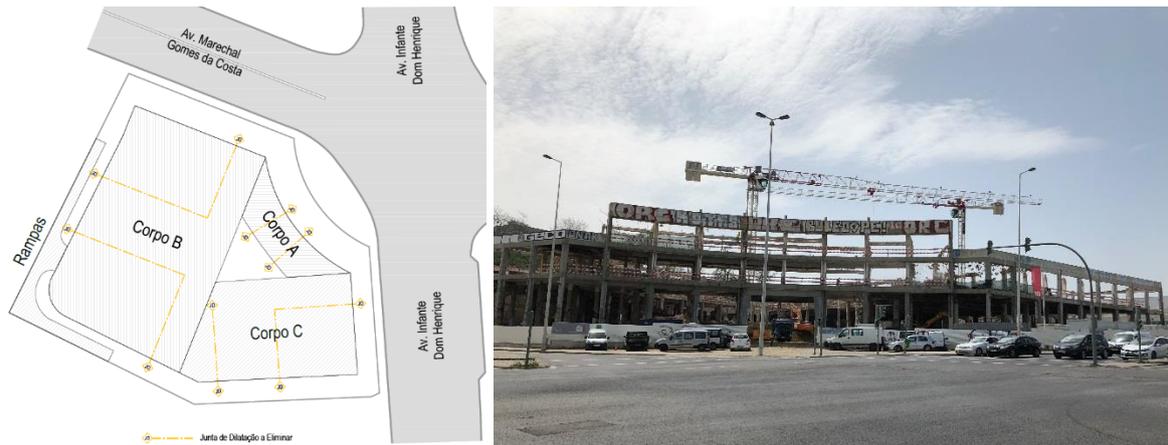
Localização do edifício e identificação dos corpos. Vista geral pelo exterior.
